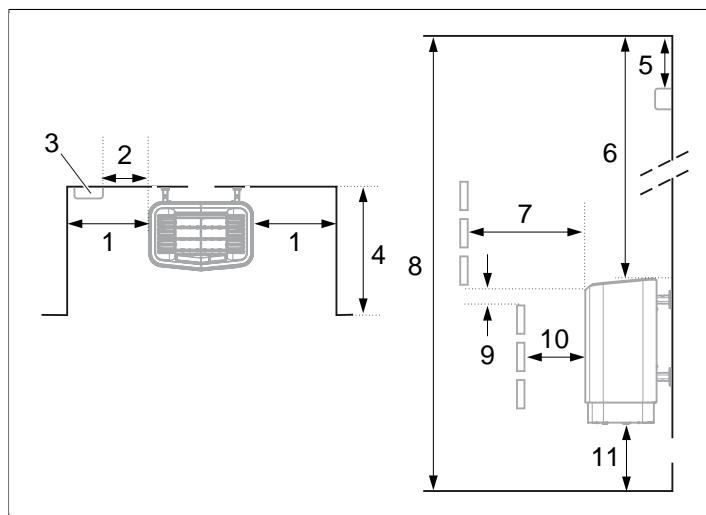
Montaż sufitowy czujnika pośrodku pieca, patrząc od przodu i z boku
